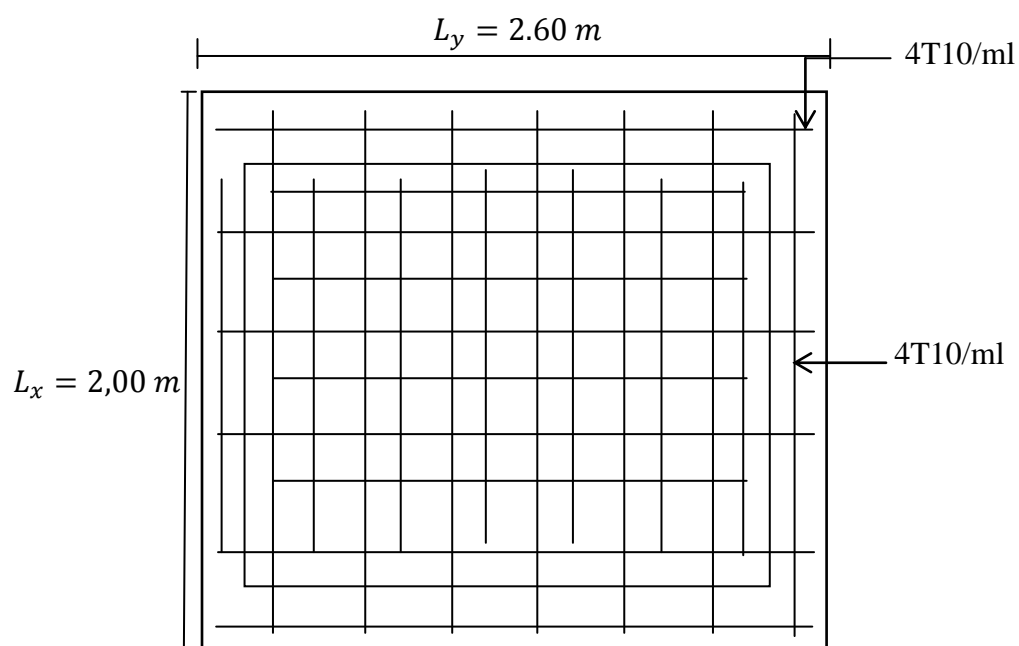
Ferrailage inférieur de la dalle de l'ascenseur
